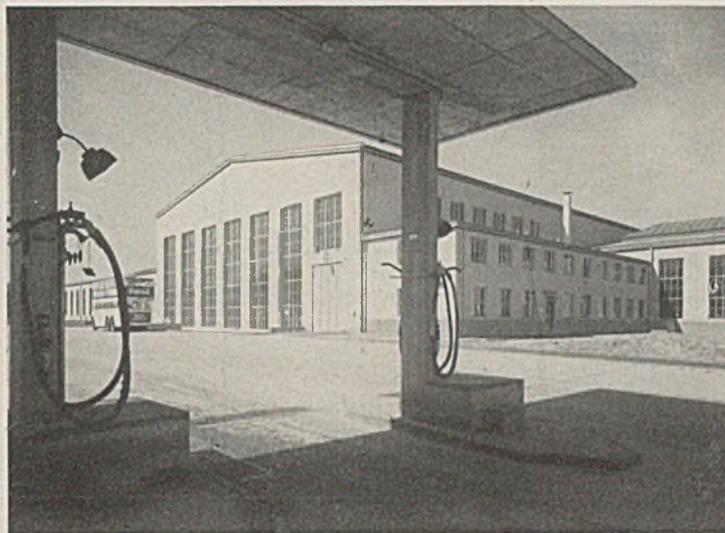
Halle II. Außenansicht. Im Vordergrund die Tankanlage.
